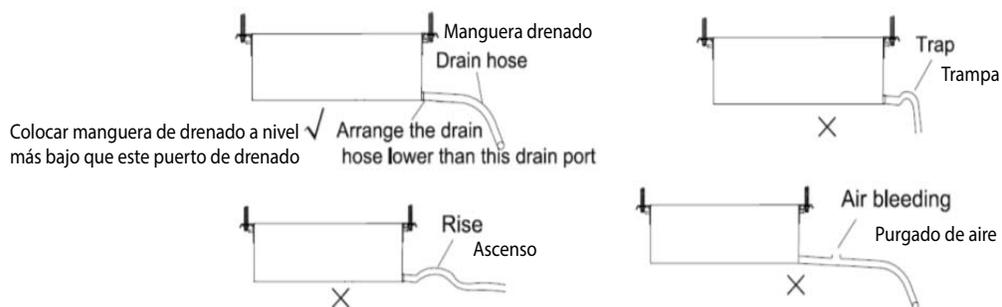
Instalación de tubería de drenado - Vista A y Vista B
